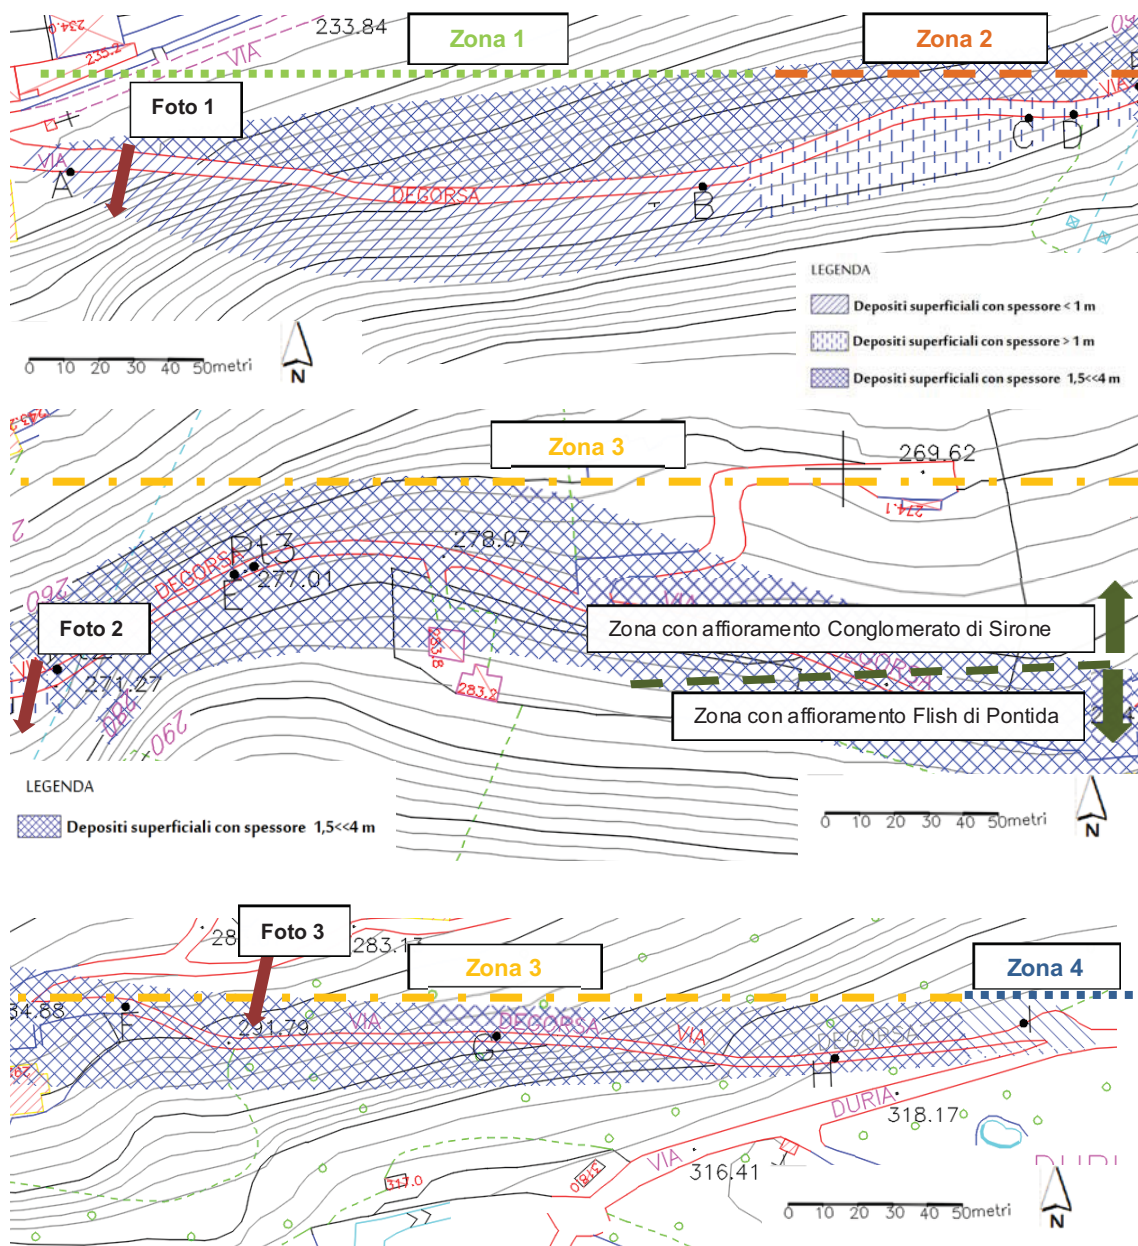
estratto planimetria del rilievo con ubicazione documentazione fotografica e suddivisione in zone della strada.
